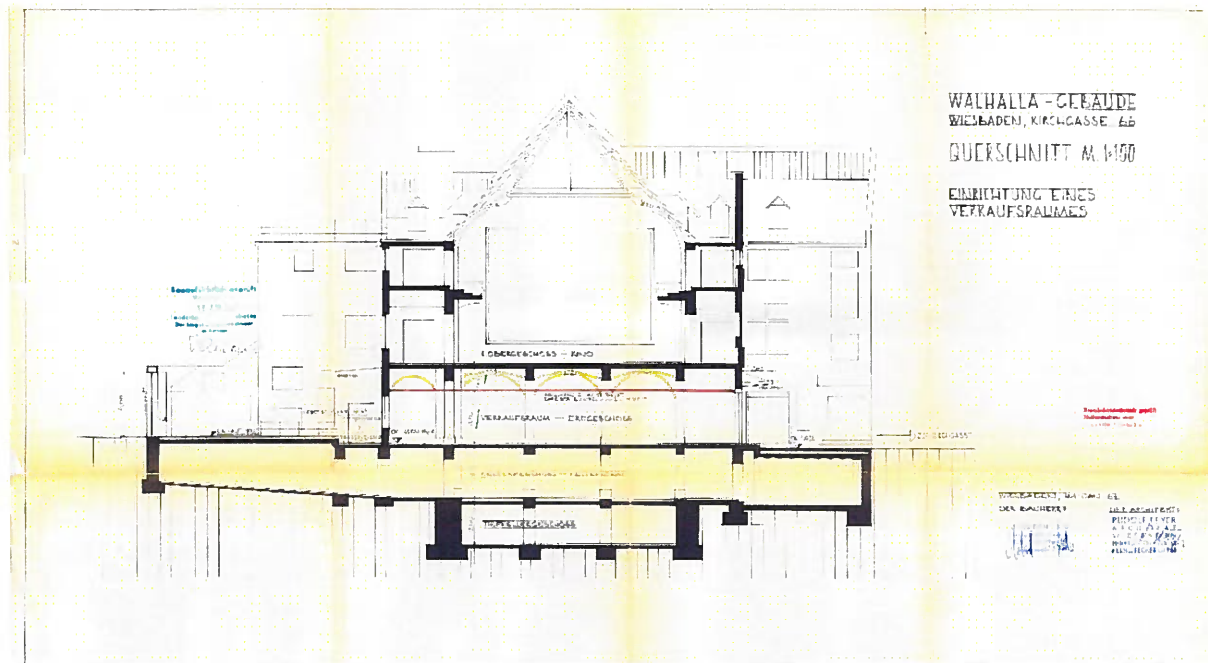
Antragsplanung: Verkaufsnutzung im Erdgeschoss, Bauakte Stadt Wiesbaden
